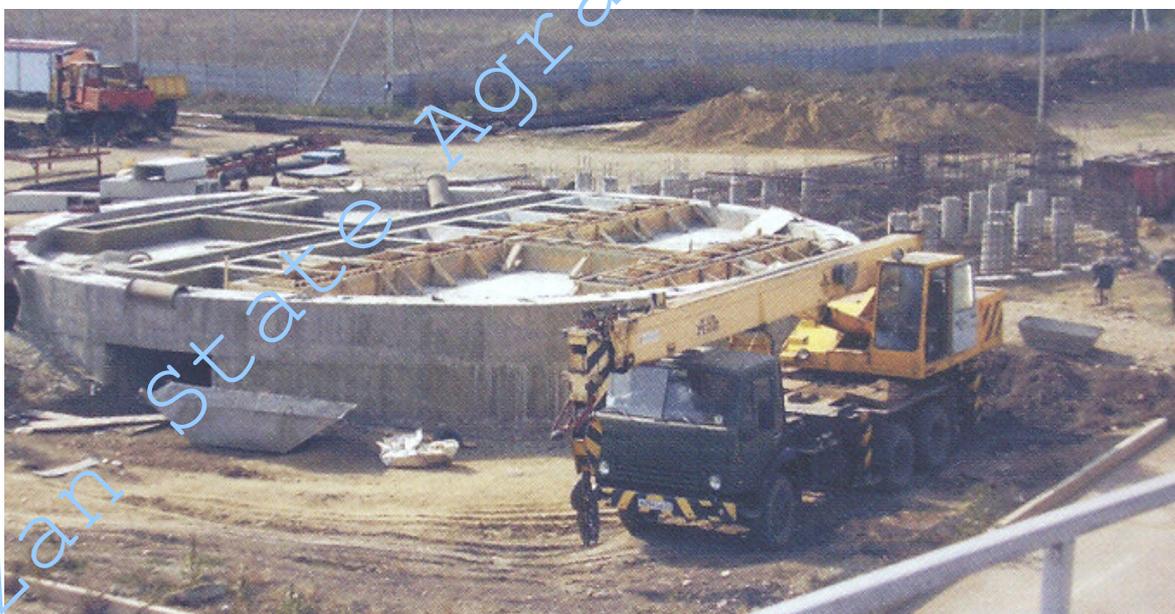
Фундаментная плита под металлический силос вместимостью 3000 тонн
